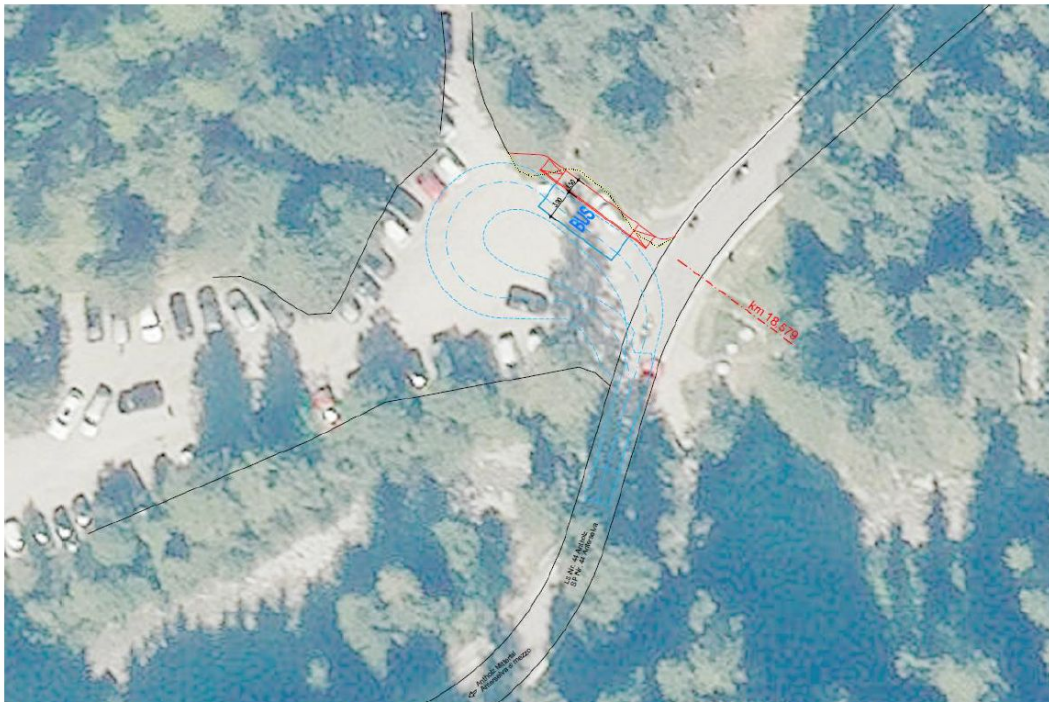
Auszug Projektlageplan Haltestelle „Platzl am See“ / estratto planimetria „Piazzetta al Lago“
